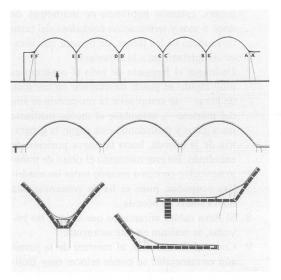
Detalles constructivos de las cáscaras autoportantes (Dieste 1987)
